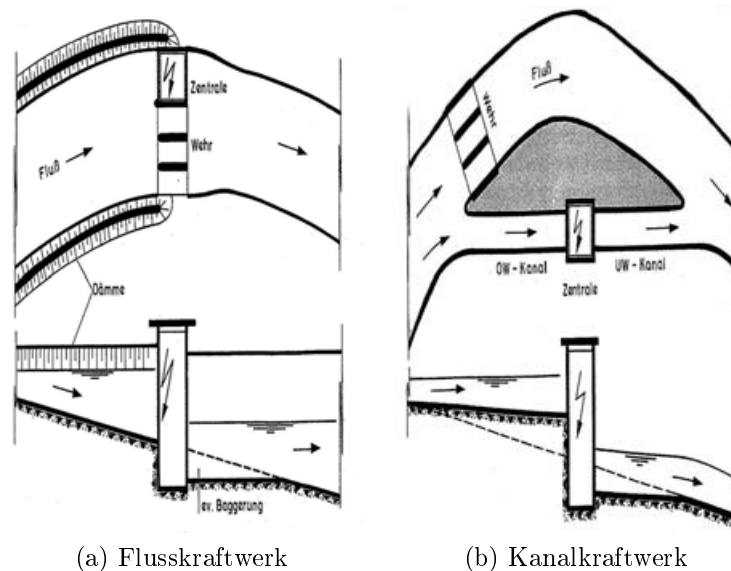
Typen von Niederdruckanlagen im Grundriss und Längsschnitt [22, S.257]
